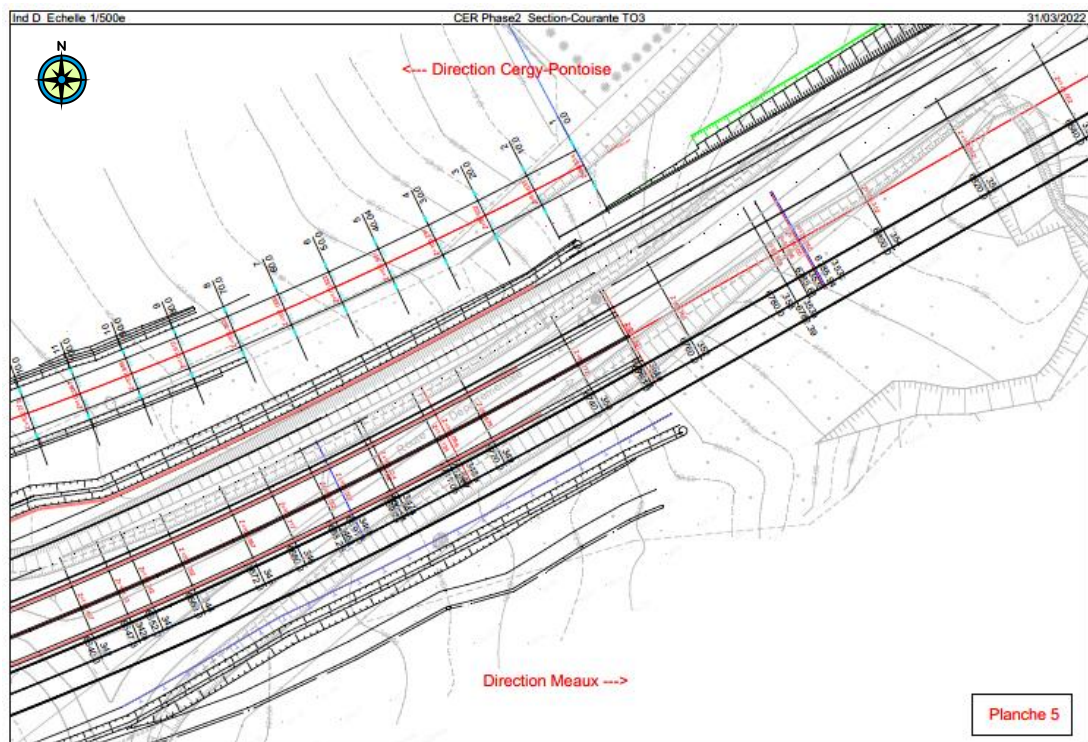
CER phase 2 Section Courante T03 – Planche 5
